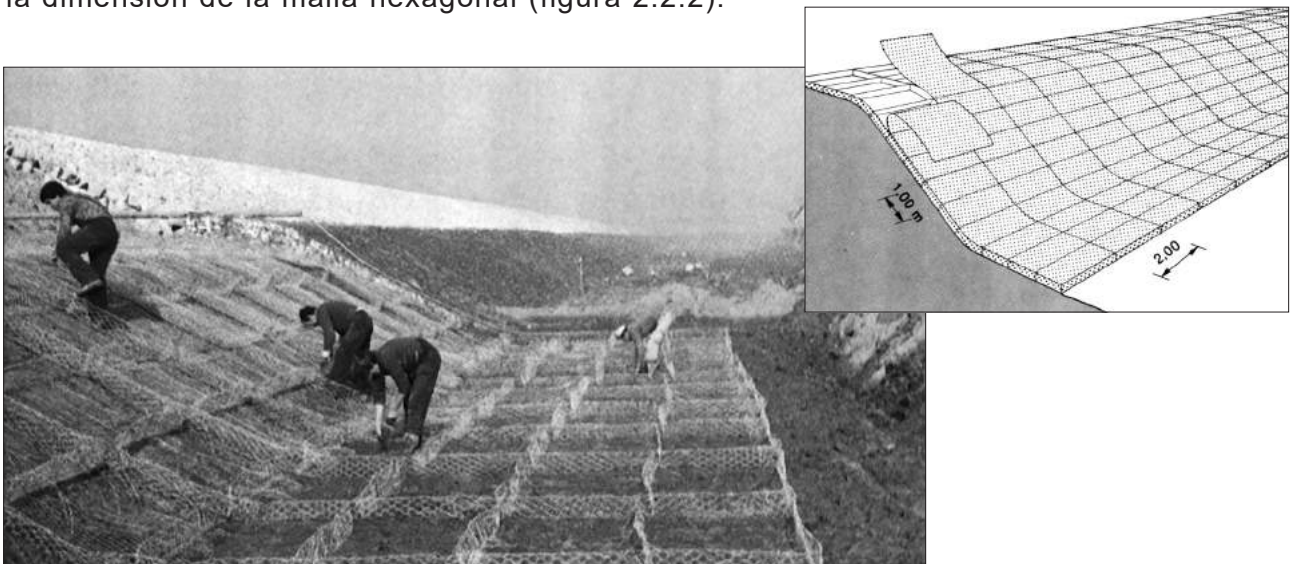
Ensamblaje de colchones Reno®.
